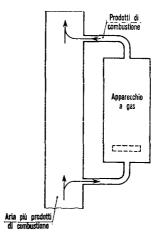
Installazione di un apparecchio a gas sul condotto
